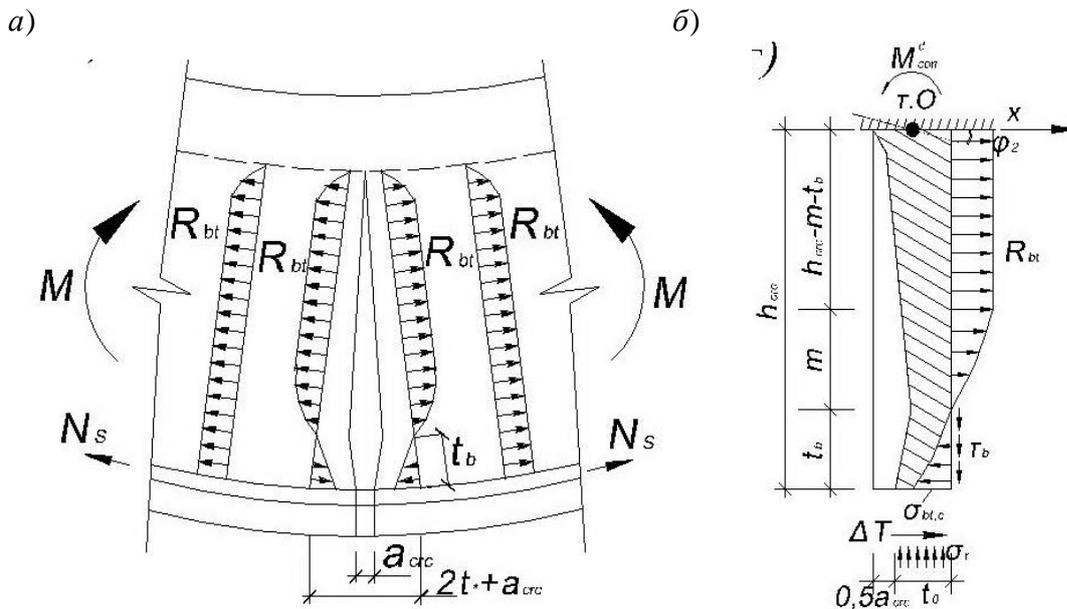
Сечение в момент образования трещины железобетонного изгибаемого элемента (а); модель двухконсольного элемента (б)
